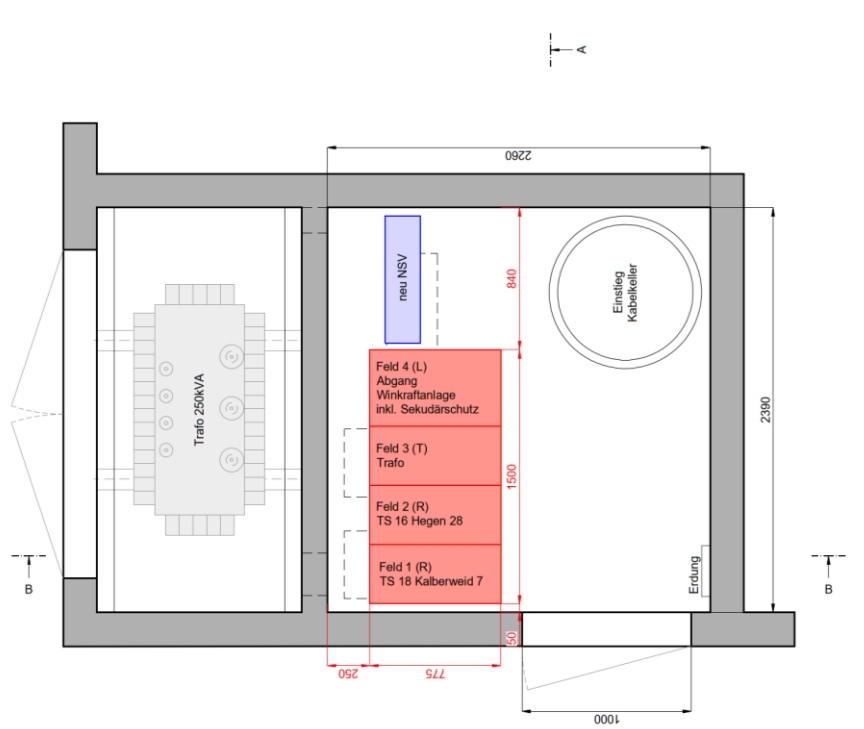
Dispositionsplan mit geplanter Stationsanordnung.
